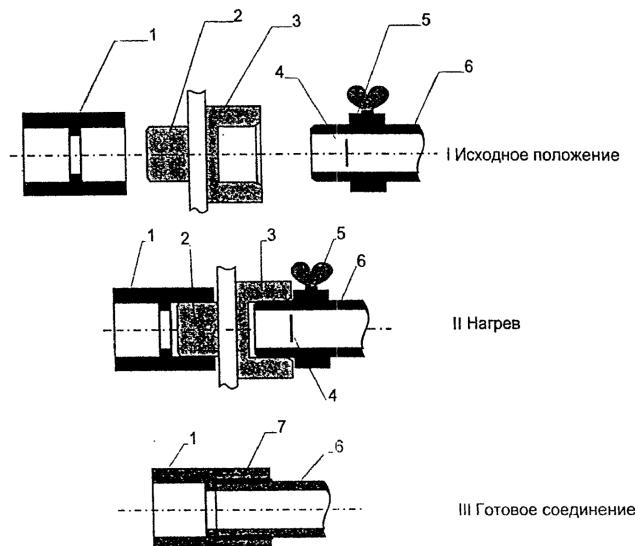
Последовательность процесса контактной сварки в раструб трубы и муфты из PPRC 1 - муфта; 2 - дорн нагревательного устройства; 3 - гильза нагревательного устройства; 4 - метка на внешней поверхности конца трубы; 5 - ограничительный хомут; 6 - труба; 7 - сварной шов
